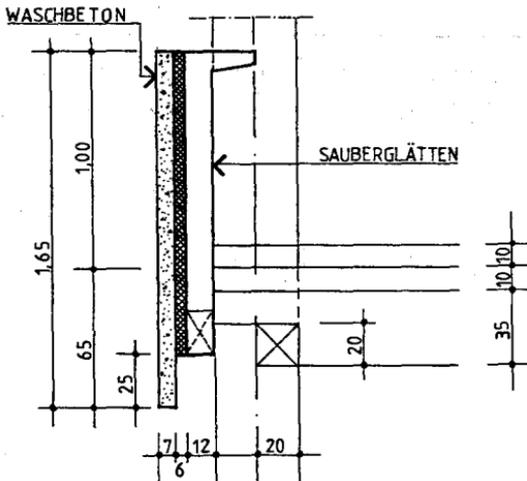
Aufbau der Brüstungselemente eines Bürogebäudes (Fa. Lehde)
